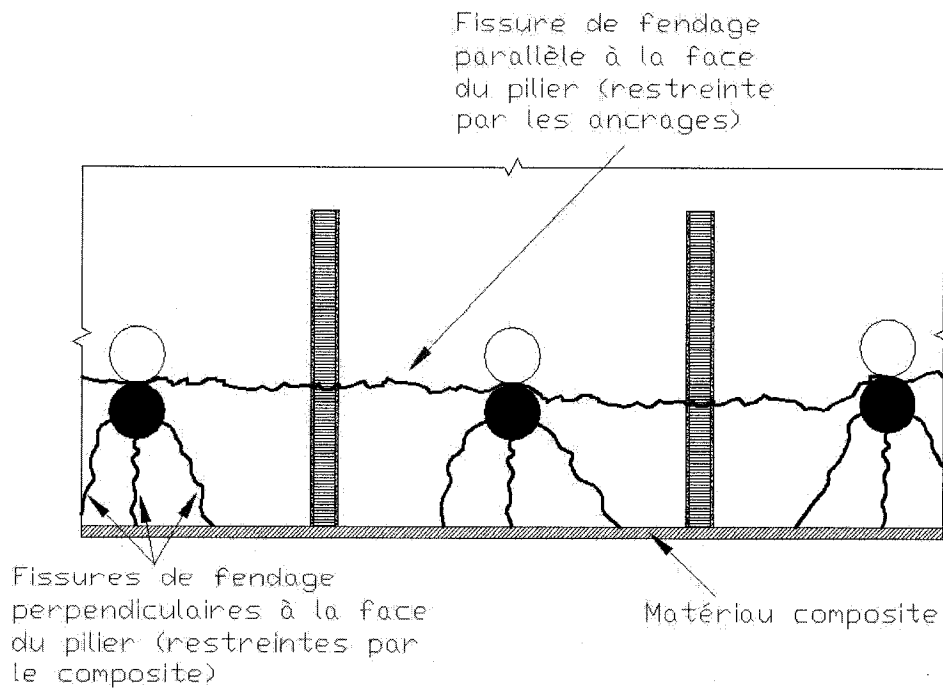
Renforcement d'un pilier à l'aide d'ancrages et de matériau composite
